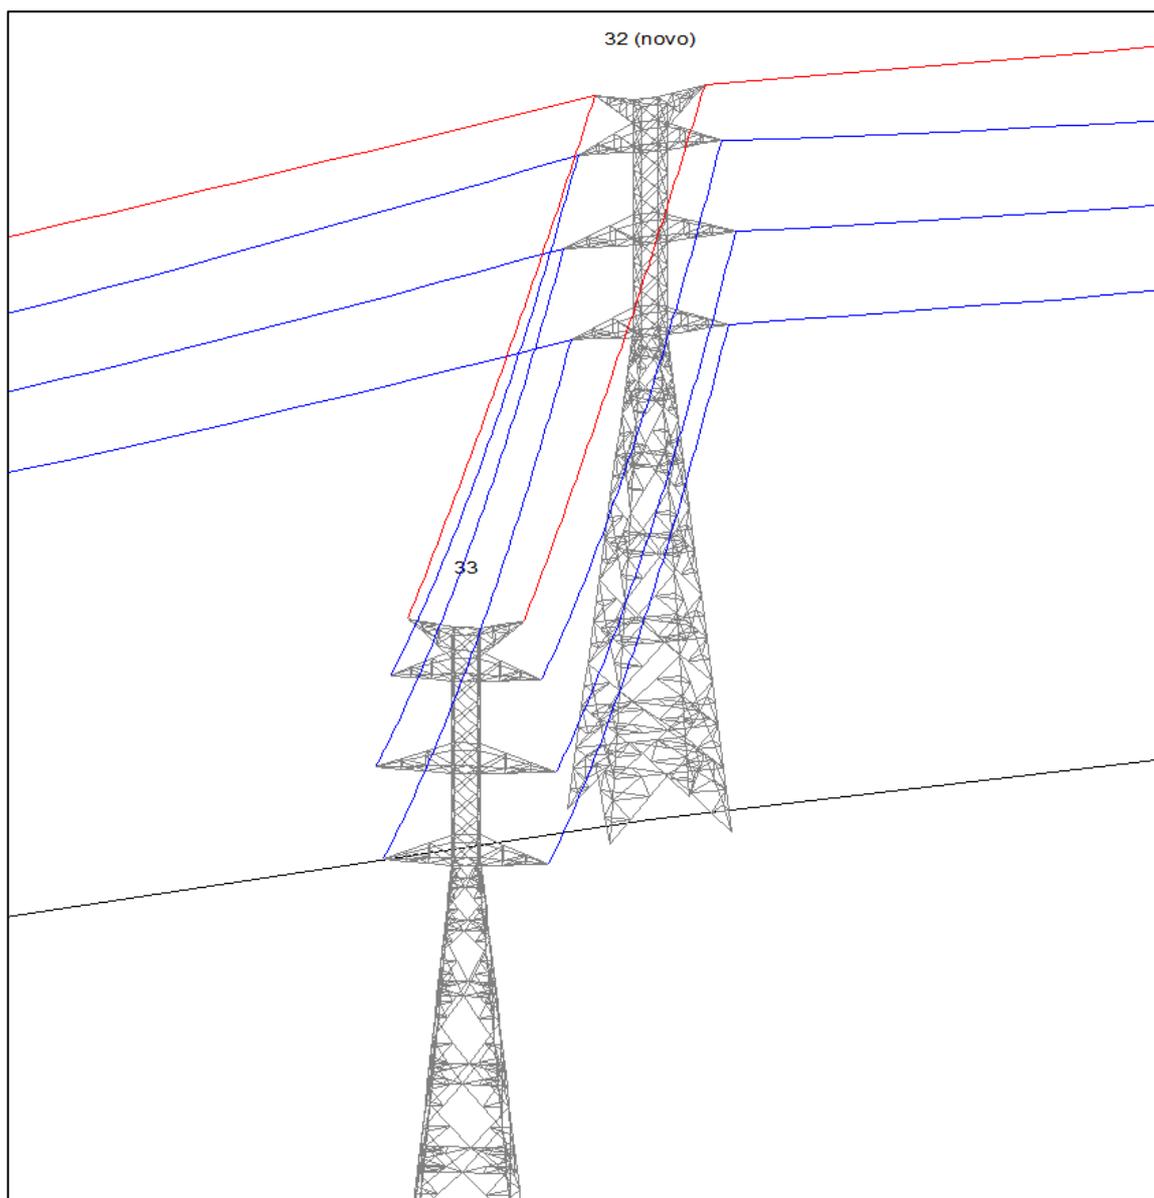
Abertura da LCDRA2 - Postes 32 e 33 a construir.
